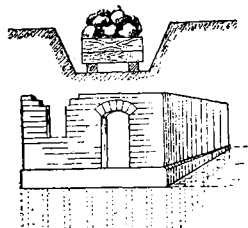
Determinarea rezistenței solului - Fundație cu piloți, legături, planșeu și bloc de beton
